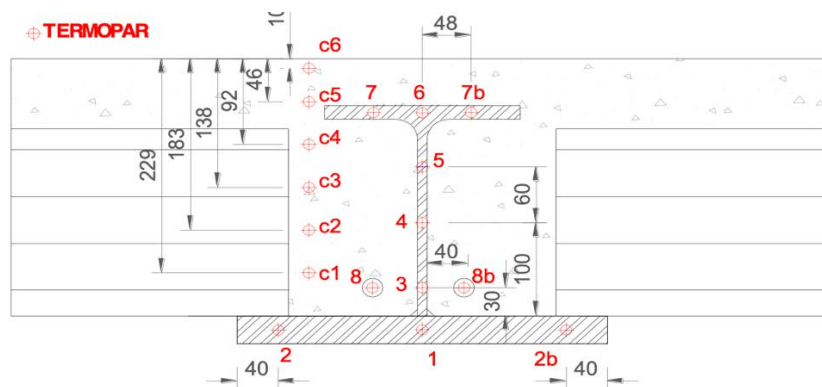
Plano de ubicación de termopares en la sección central. Sección IFB.
